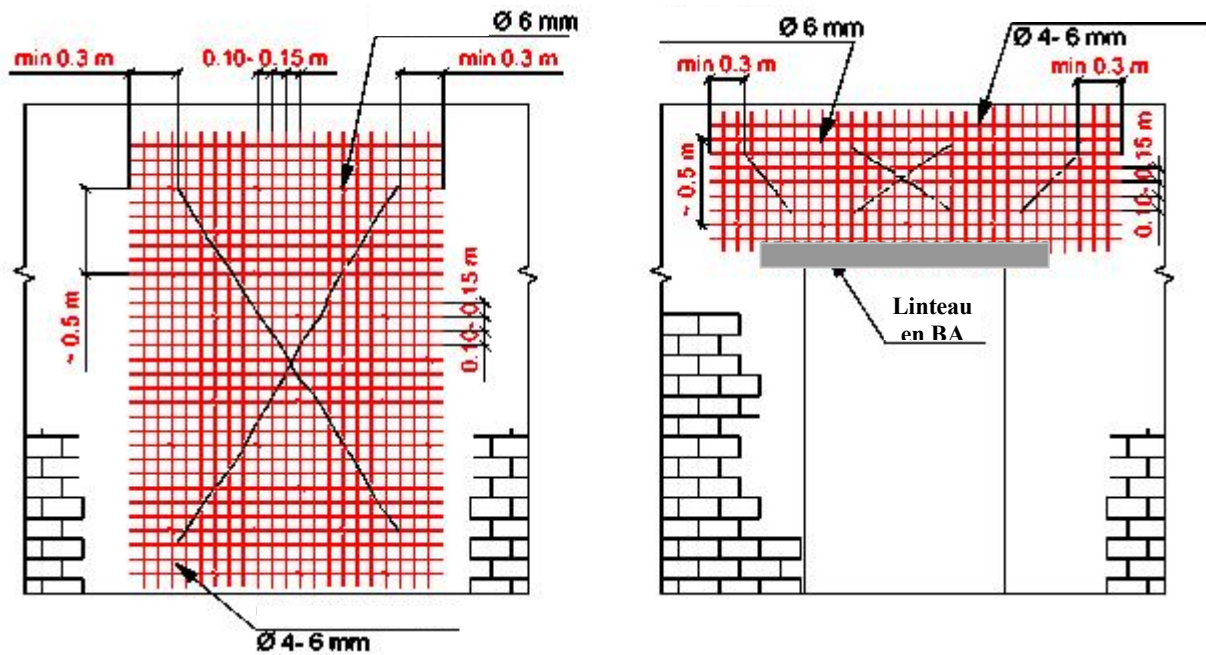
Renforcement d'un mur et d'un linteau fissurés par des grilles métalliques
